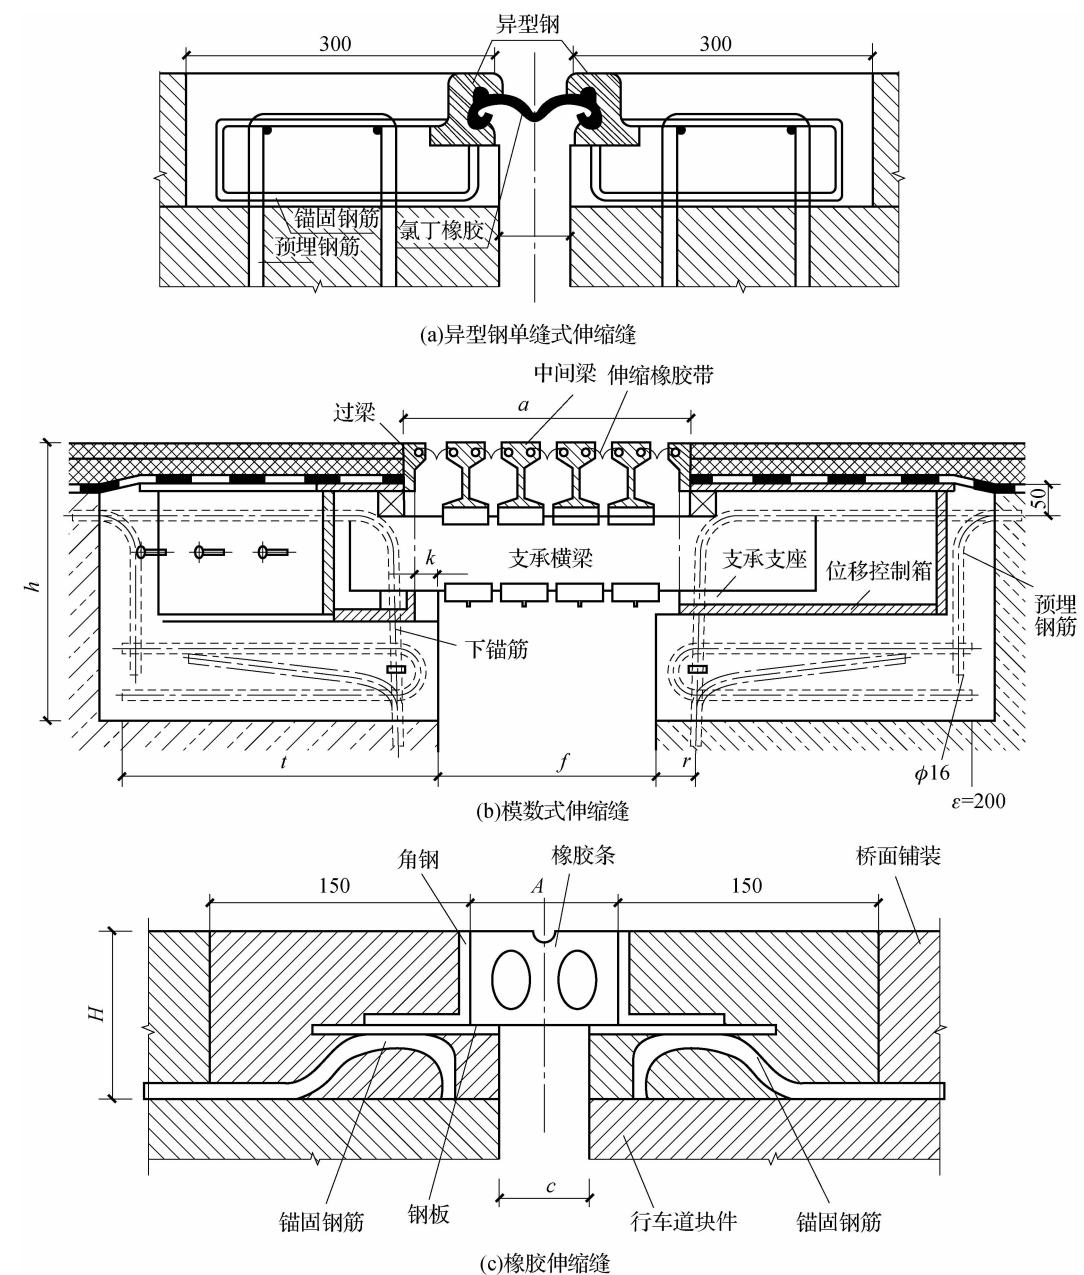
常用伸缩缝装置构造(尺寸单位:mm)
